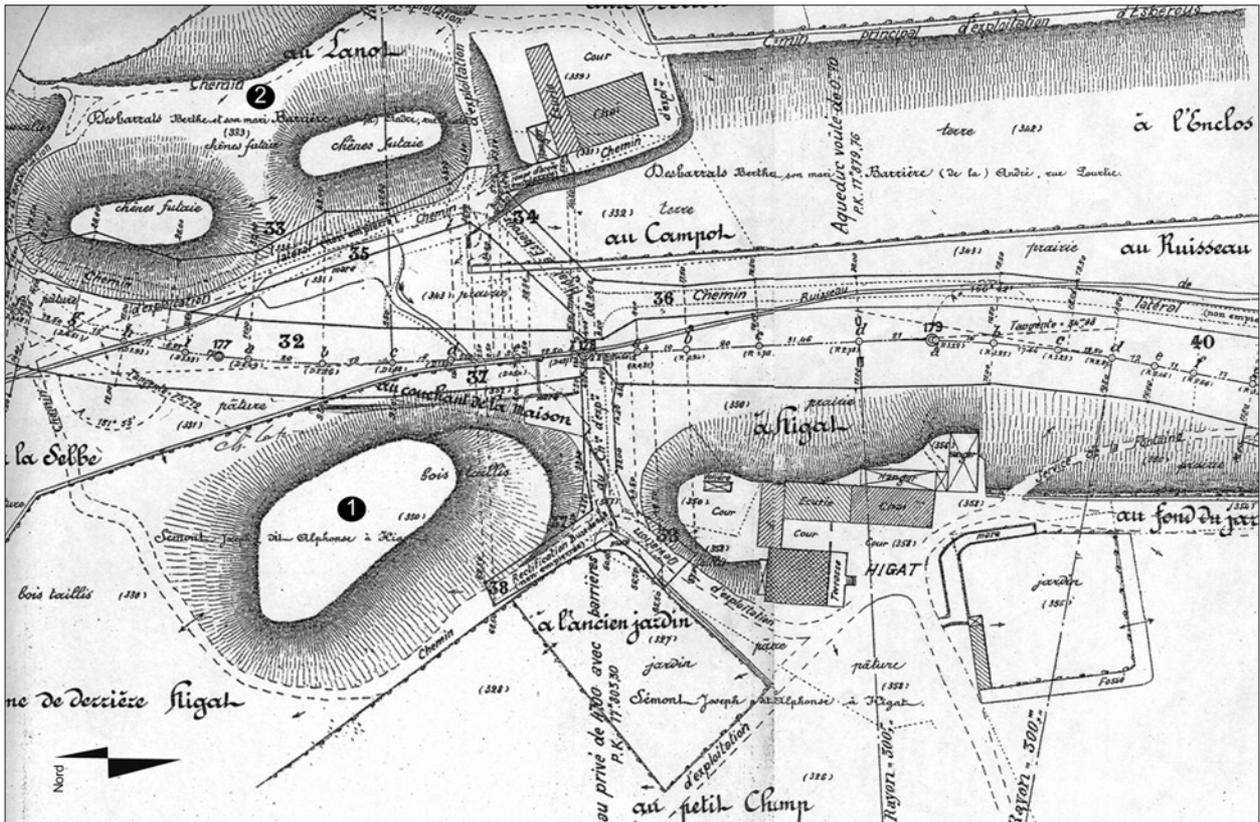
PLAN DES TRAVAUX prévus pour la construction de la voie ferrée Eauze-Nérac (vers 1910, les numéros renvoient à la fig. 2).
